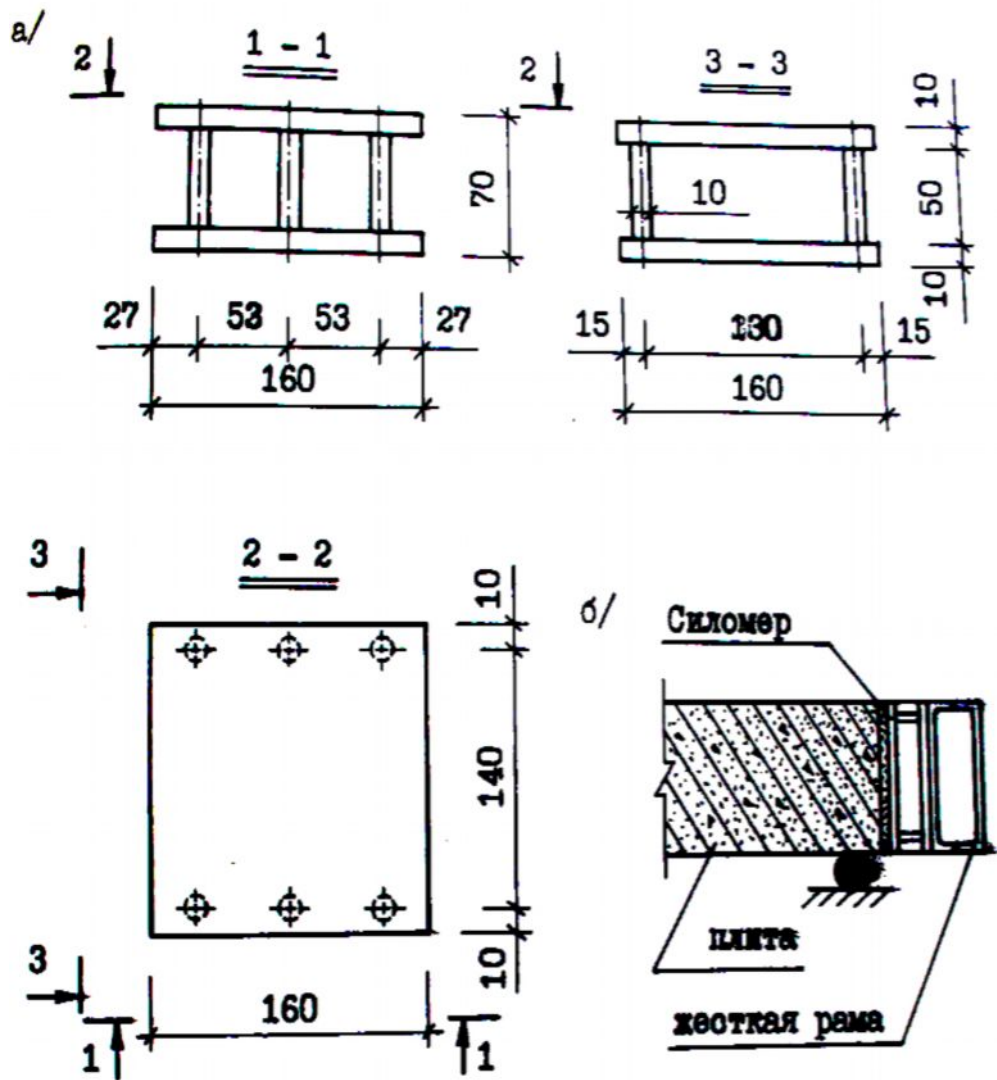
Силомерные конструкция и узел сопряжения сборных железобетонных плит перекрытий
